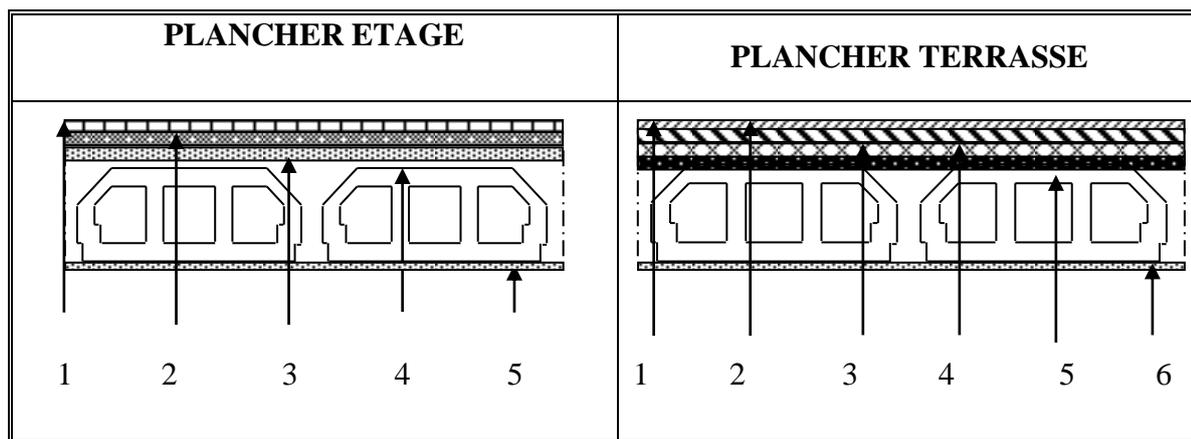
caractéristique de plancher étage et plancher terrasse.
